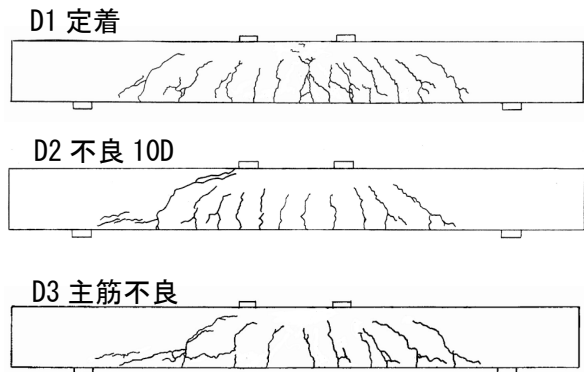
ひび割れ性状 (D1~D3 実験)
